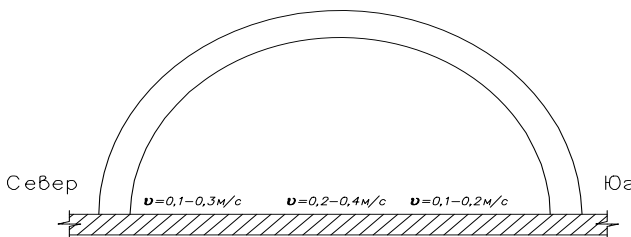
Поле движения воздуха внутри пневмоопорной конструкции
